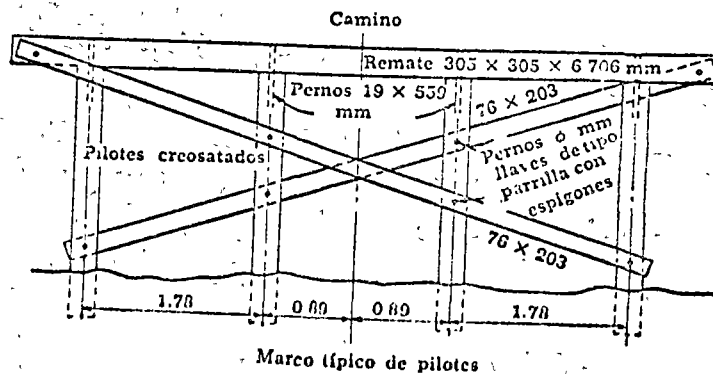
PUENTE DE LARGUEROS Y TABLONES, CON PAVIMENTO DE ASFALTO
